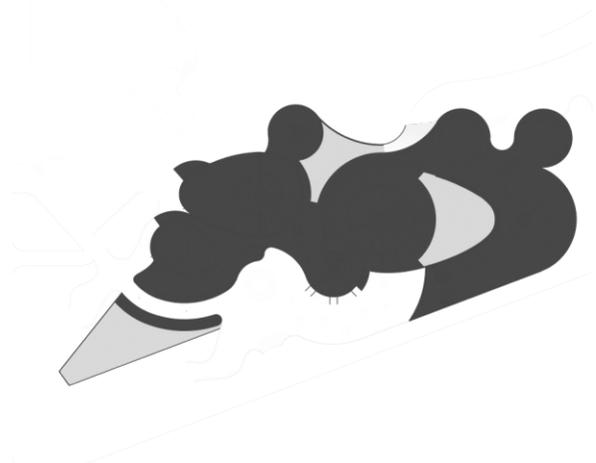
Flächennachweis. KG Grundrisse, Niveau -7,80
